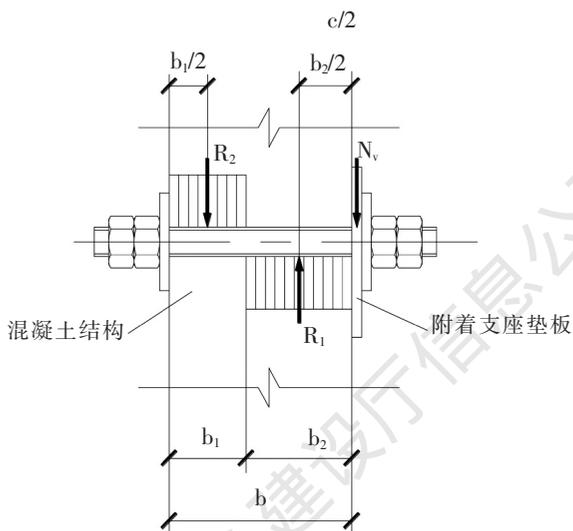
穿墙螺栓孔处混凝土受压状况图
